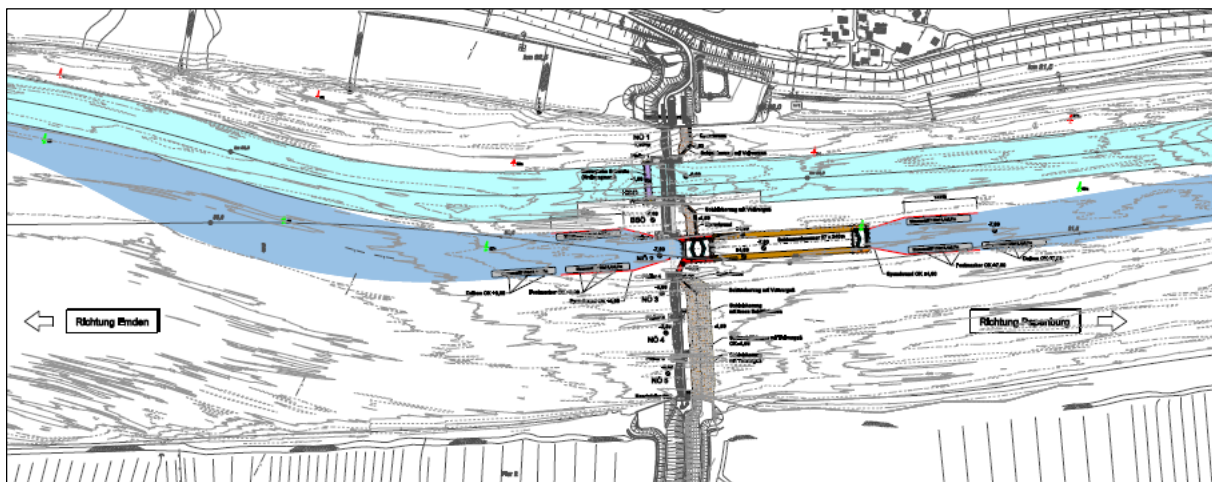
Lageplan der Gesamtvariante B.2
